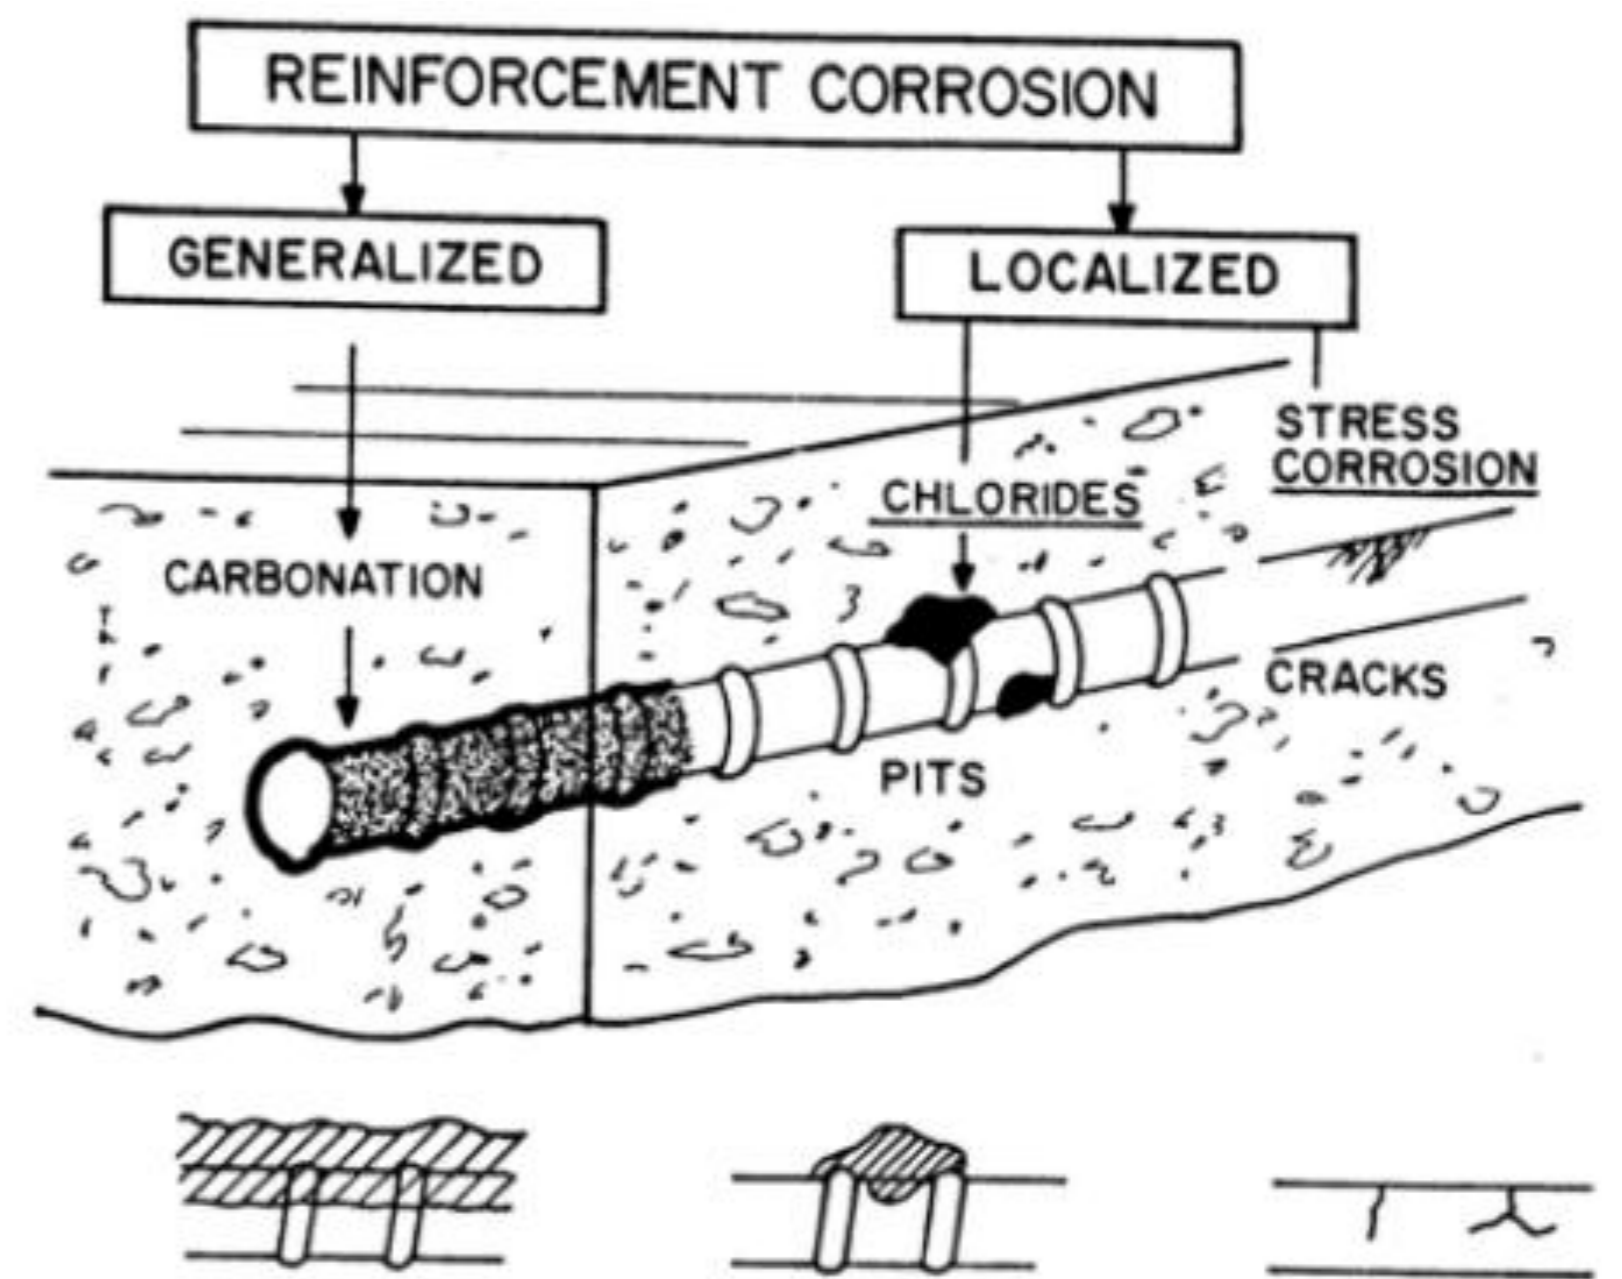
Principales mecanismo de corrosión de las armaduras embebidas en hormigón. H. Tinoco, "Protección Superficial del Hormigón Armado: Cloruros y Carbonatación," no. June 2014.
